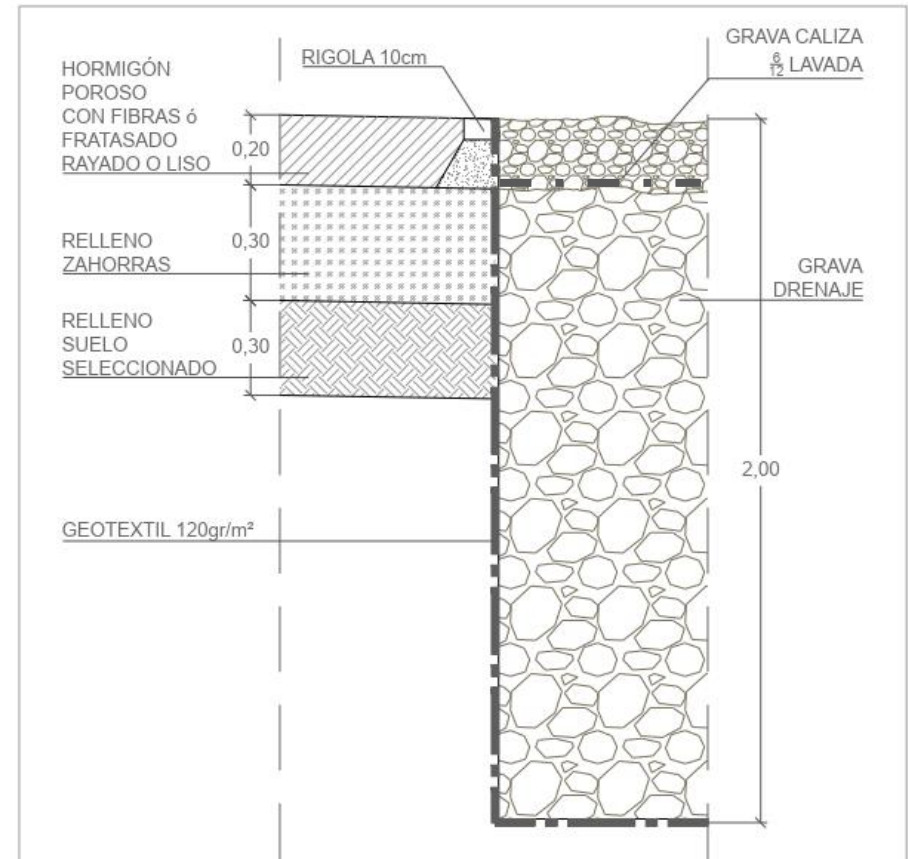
Sección constructiva de las zanjas de drenaje perimetral.
